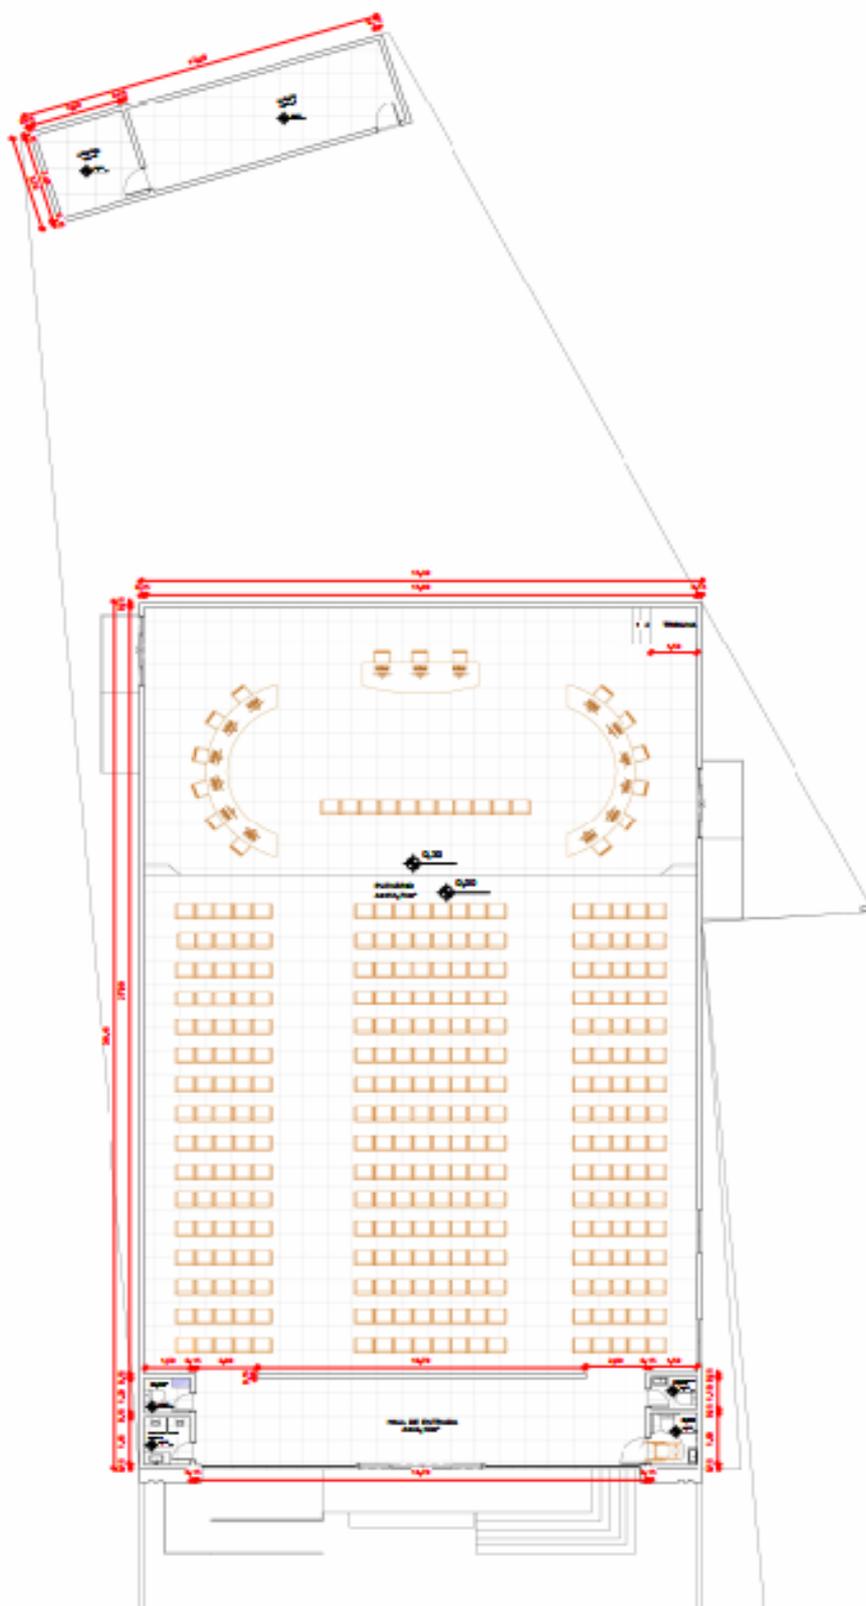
Prédio 2- Construção Plenário. Área a ser construída. Prédio do Plenário.
